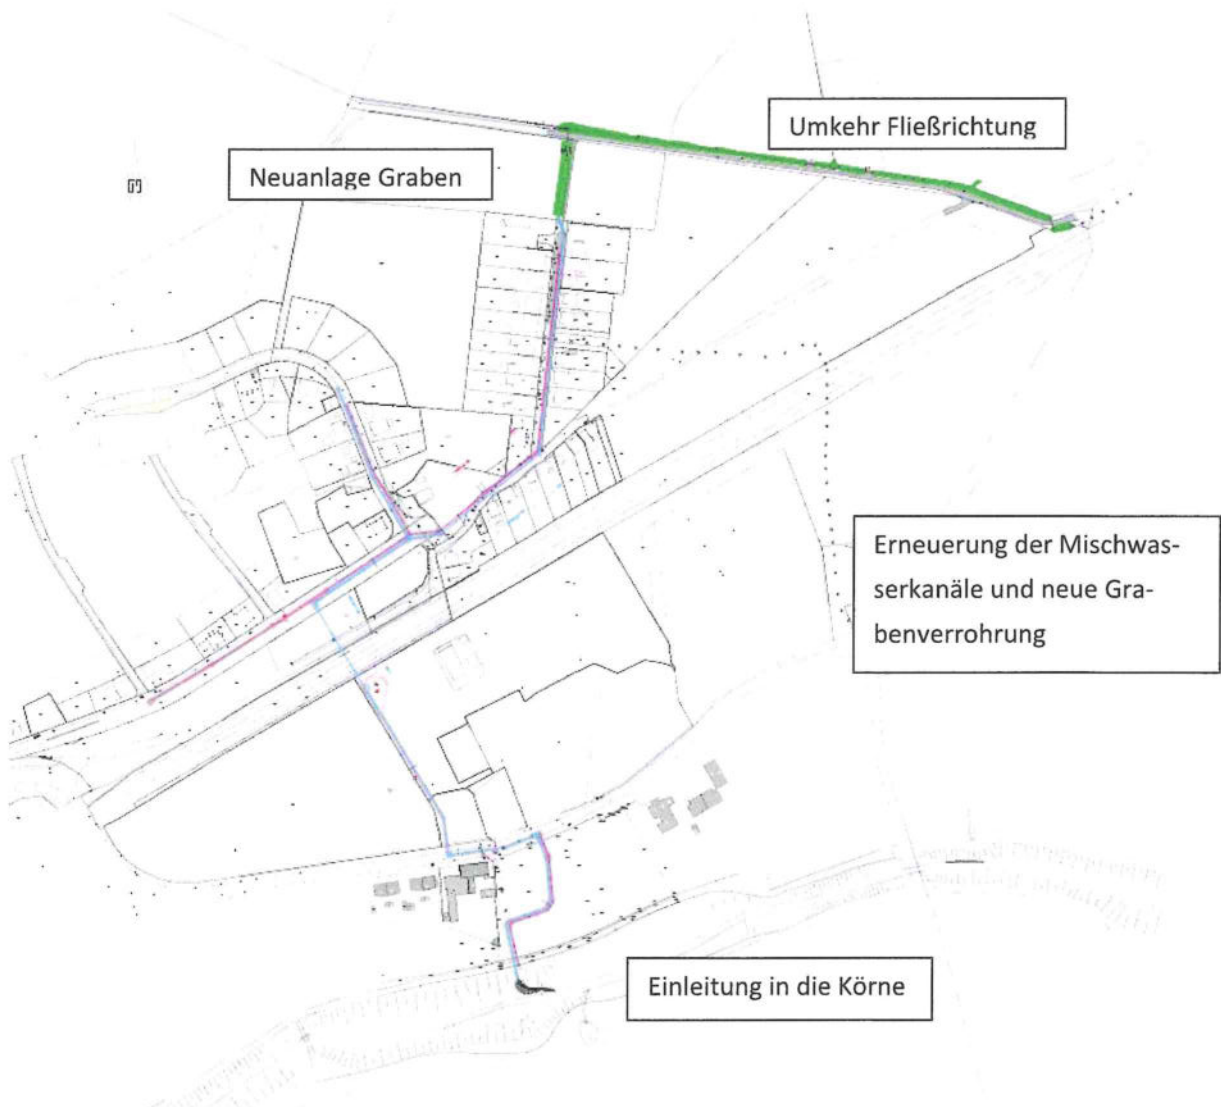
Lageplan [FISCHER TEAMPLAN 2021].
